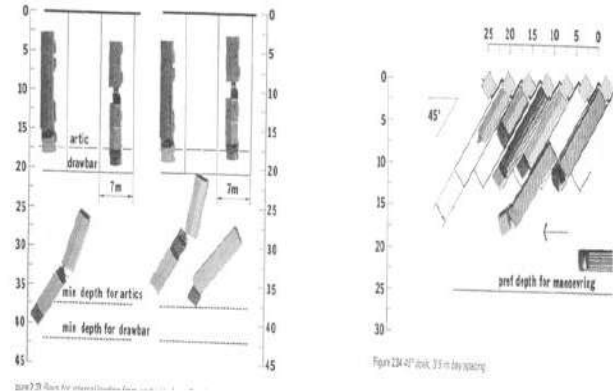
Ejemplo de Bahías a 90 grados y en ángulo. Fuente: Drury, Jolyon and Falconer Peter. “Building and Planning for Industrial Storage and Distribution”, Architectural Press, 2ª Edición, 2003.
